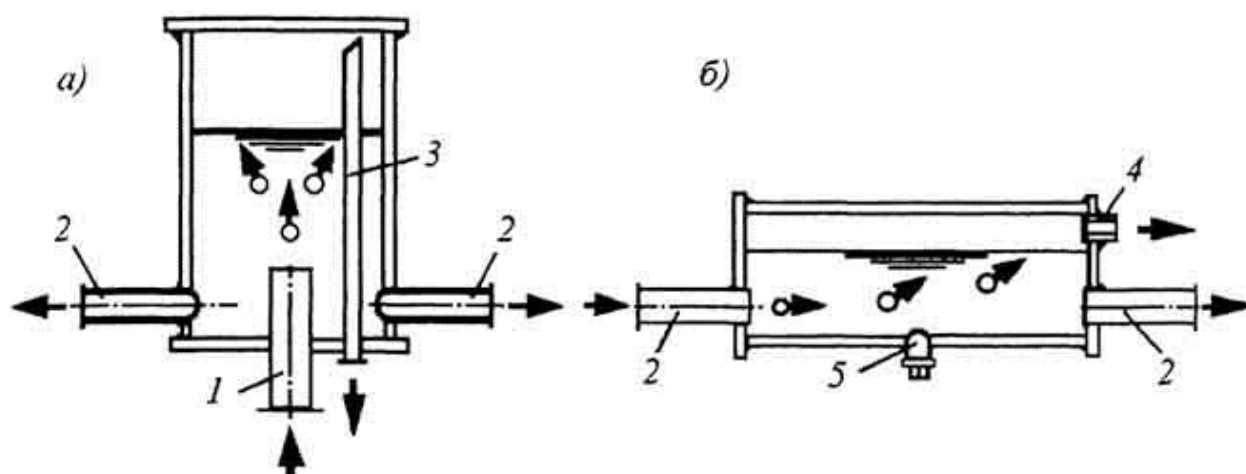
Проточные воздухоборники: *а* - вертикальный на главном стояке; *б* - горизонтальный на верхней магистрали; 1 - главный стояк; 2 - магистрали; 3 - труба D_y15 (с крапом) для выпуска воздуха; 4 - муфта D_y15 для воздуховыпускной трубы; 5 - муфта D_y15 с пробкой для удаления грязи
